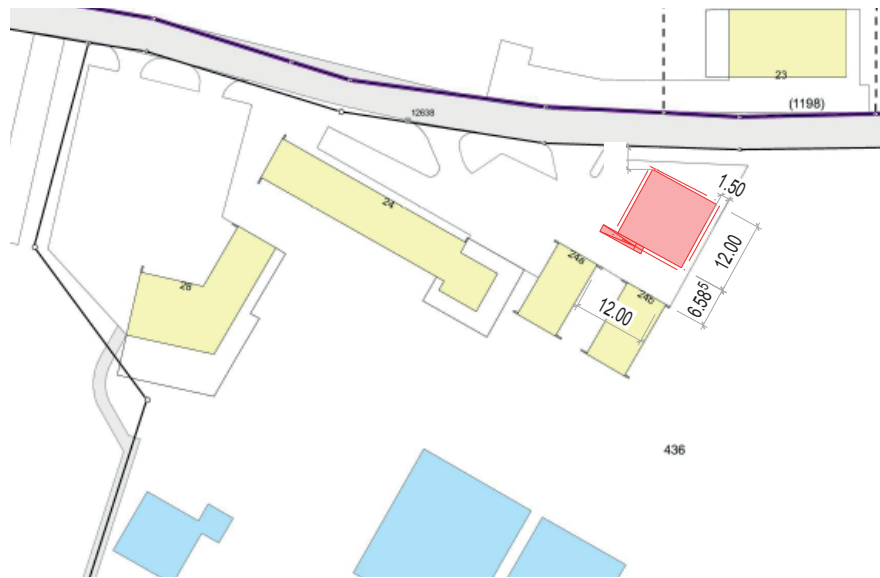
Situationsplan mit den bestehenden Gebäuden und einem möglichen Grundriss des neuen Gebäudes
